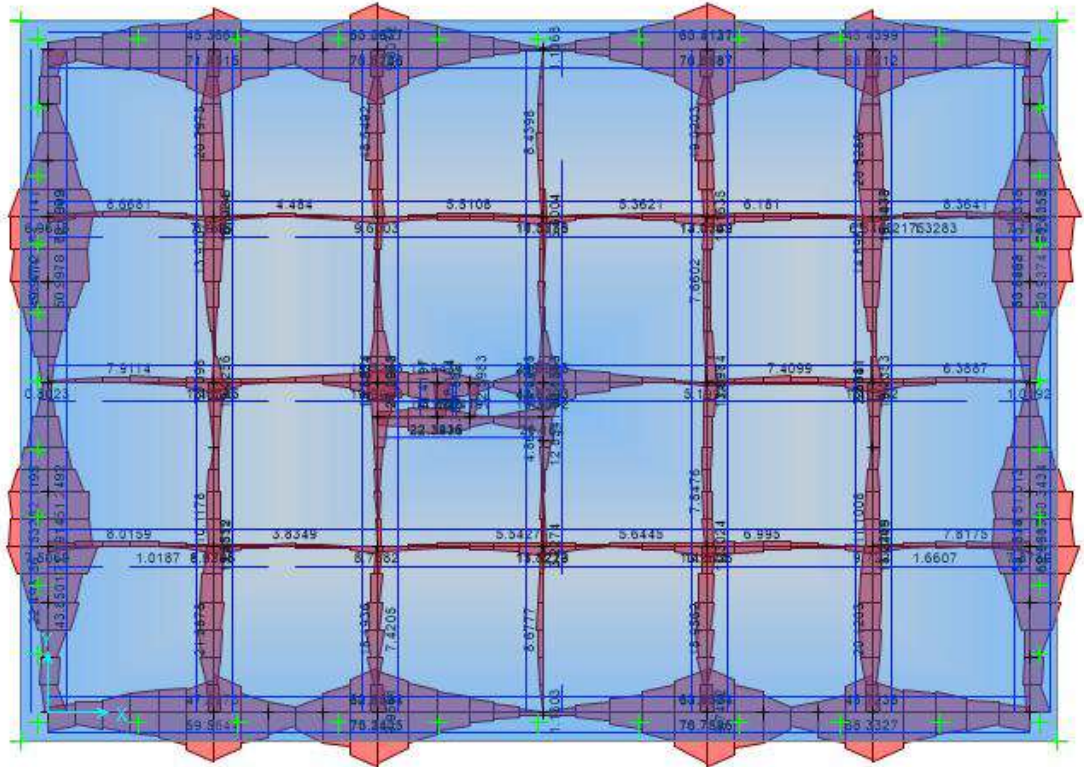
Chiclayo, Refuerzo Longitudinal en Vigas de Cimentación, 2020.
